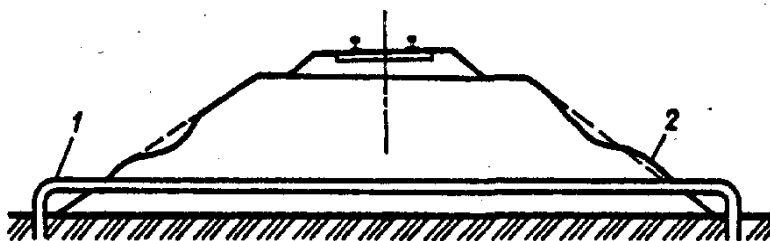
Сплывы откосных частей насыпи над пересекающей ее теплотрассой: 1 - теплотрасса; 2 - сплыв откоса насыпи
